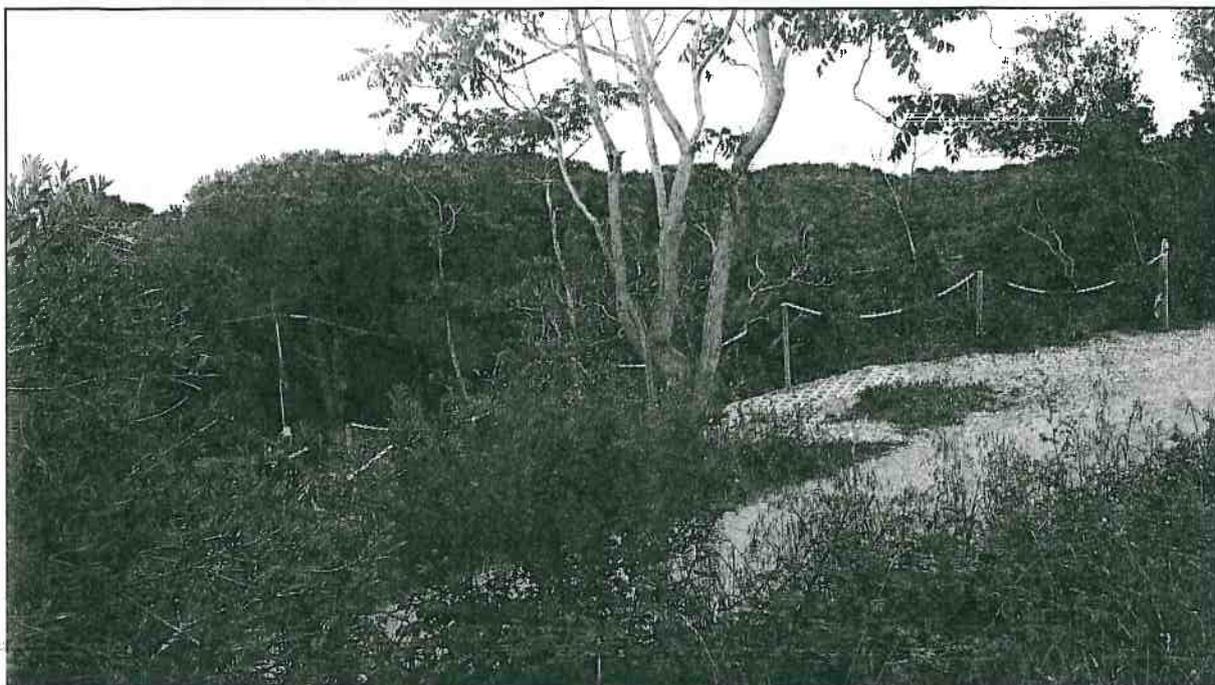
VISTA DALLA STRADA PER L'ENFOLA IN DIREZIONE DELLA RAMPA DI ACCESSO ALL'AREA PREVISTA.
